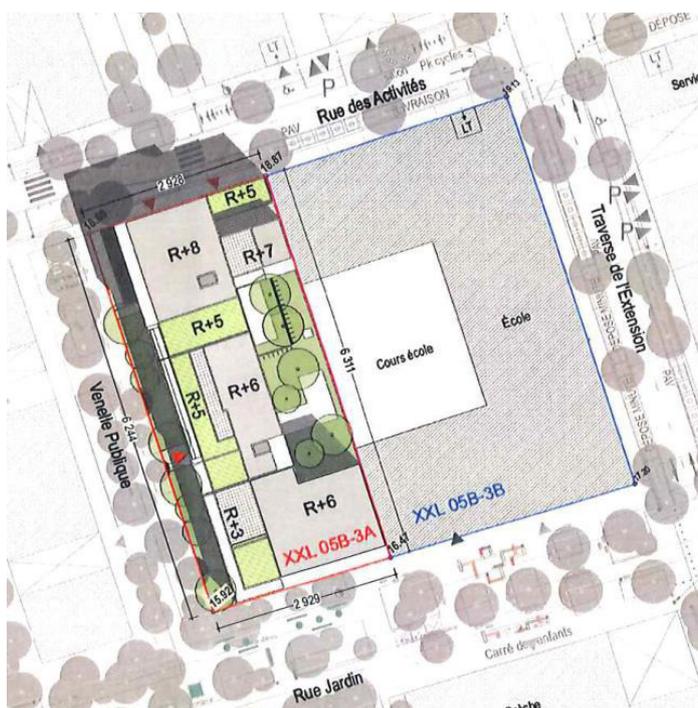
Plan masse de l'îlot 5B3a (source : Linkcity, 2019)
